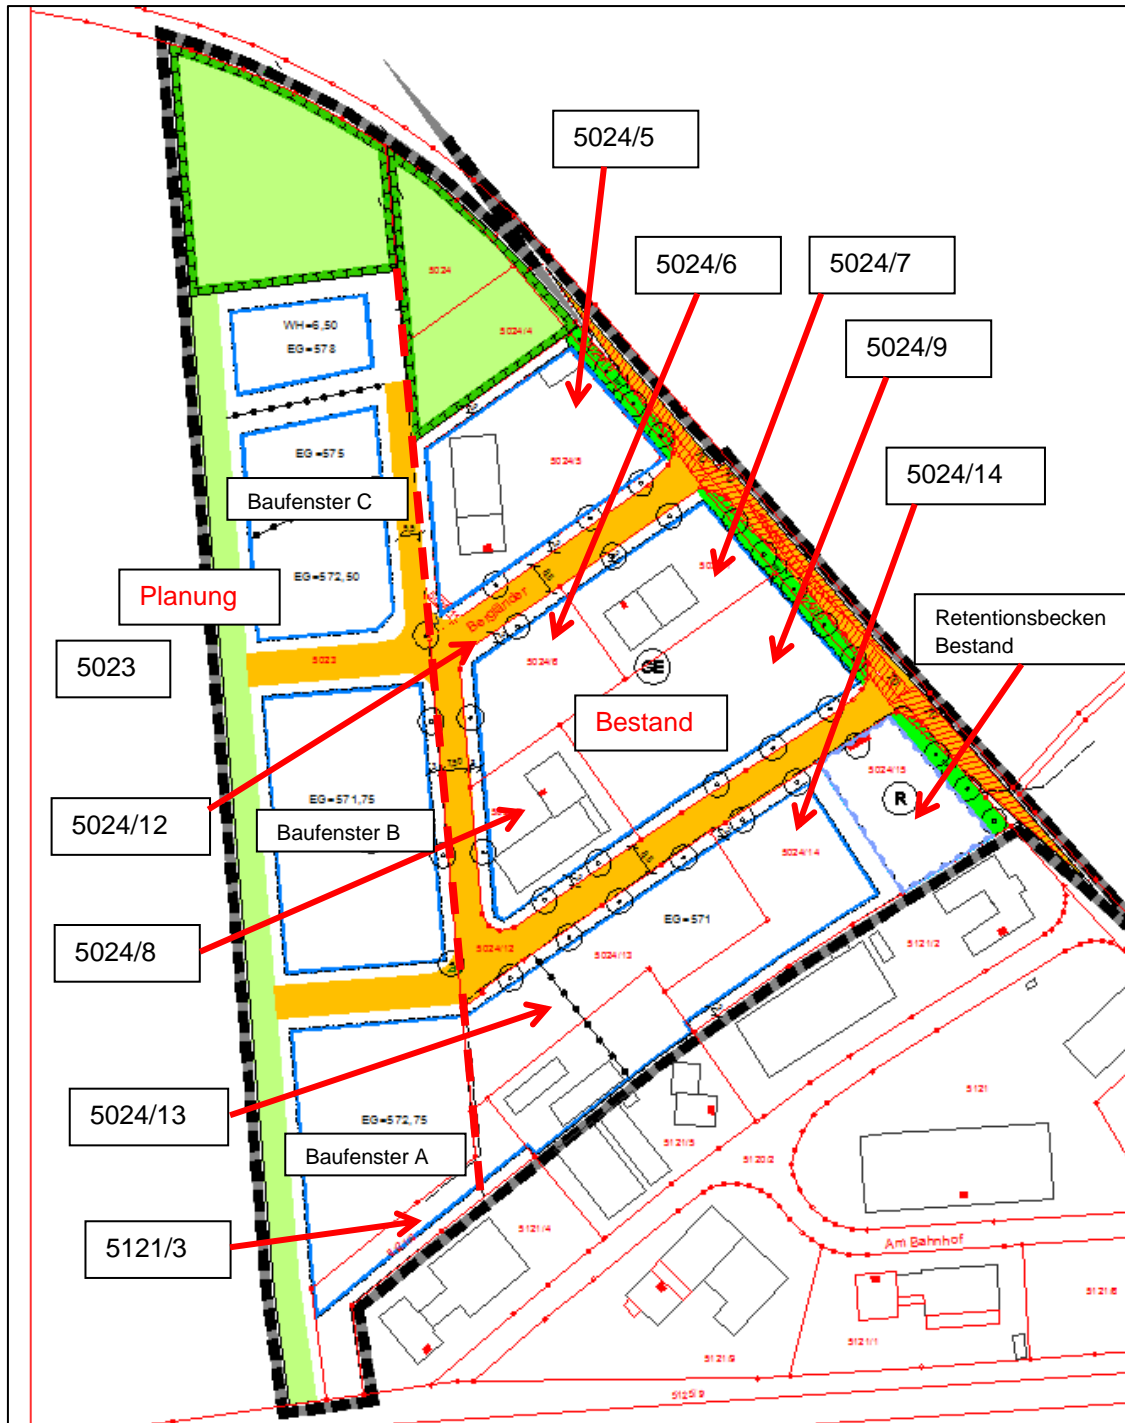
Ausschnitt Lageplan Bebauungsplanänderung; IB Strasser; Planstand 30.06.2016
